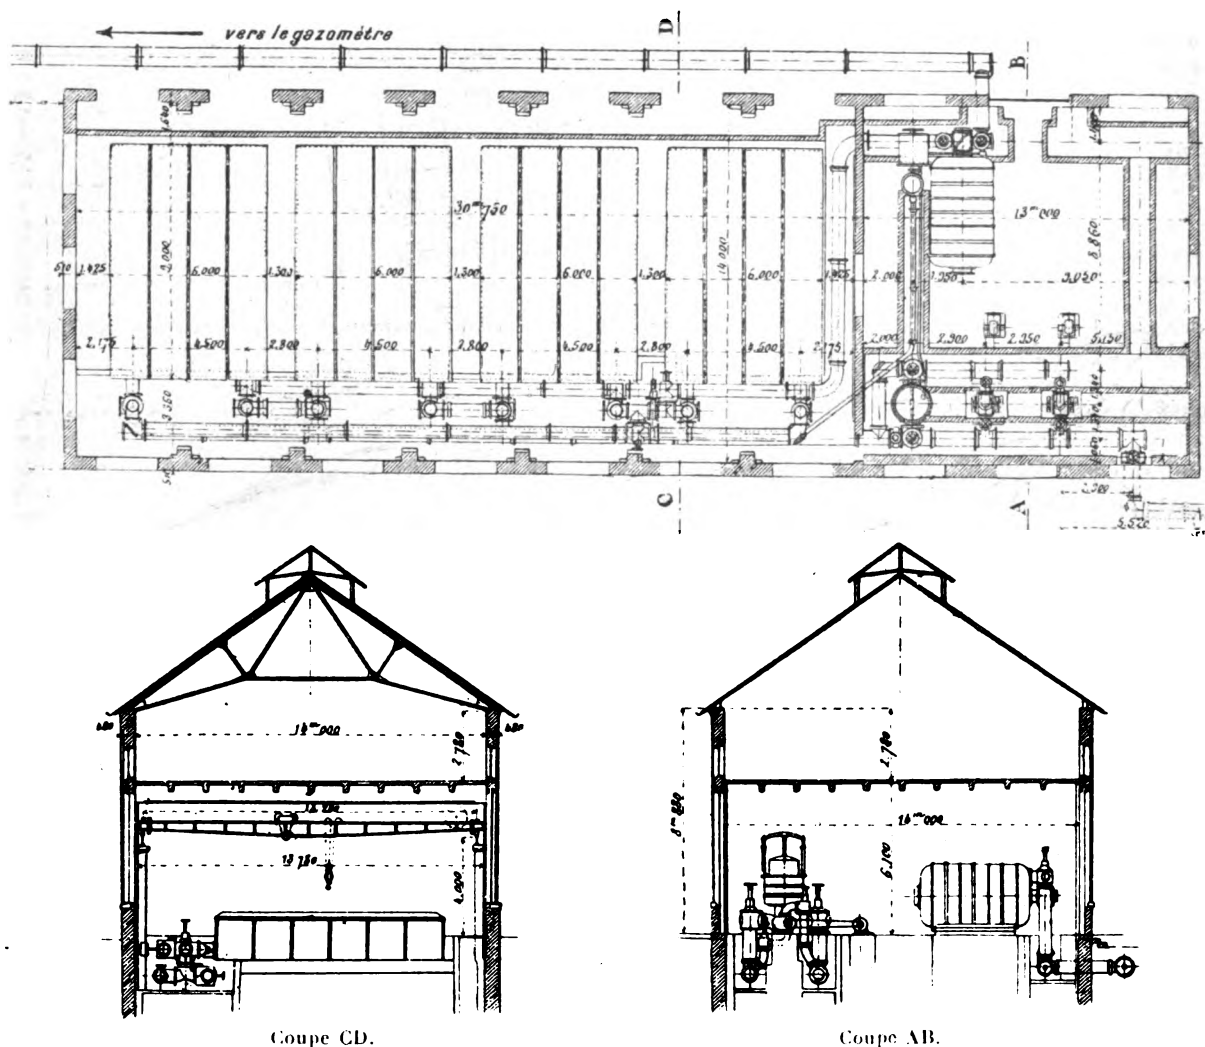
à 4. — Plan et coupes transversales de l'usine d'épuration (échelle 1/500).
